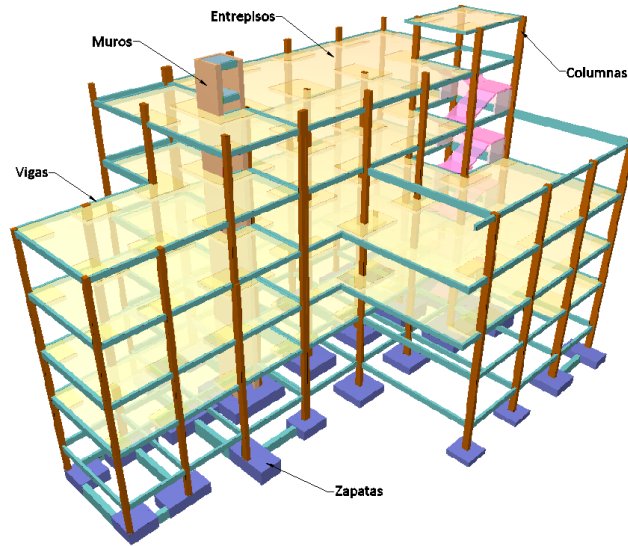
Modelo Estructural Estructura de Sustentación Edificación, Elaboración Propia
